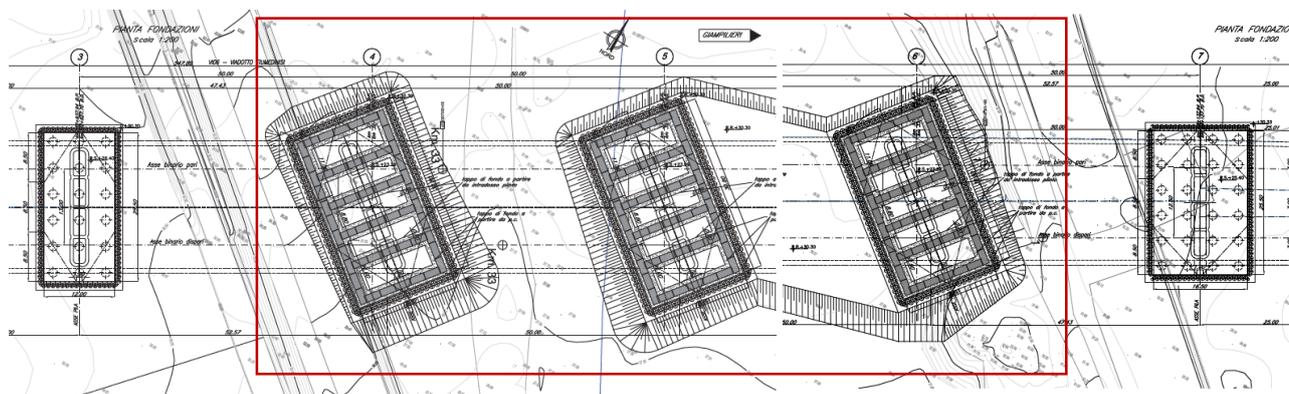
Viadotto VI03 – PE – Pianta scavi fondazioni
